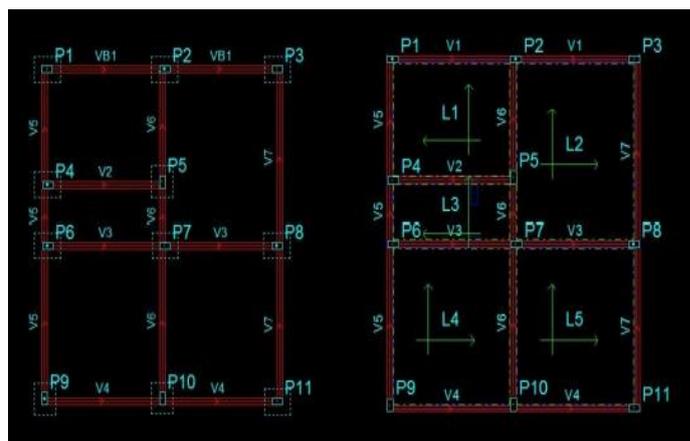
Planta estrutural de fundação e térreo, respectivamente.
